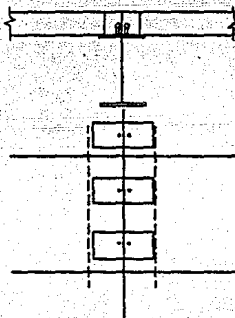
CONECTORES SOLDADOS.
